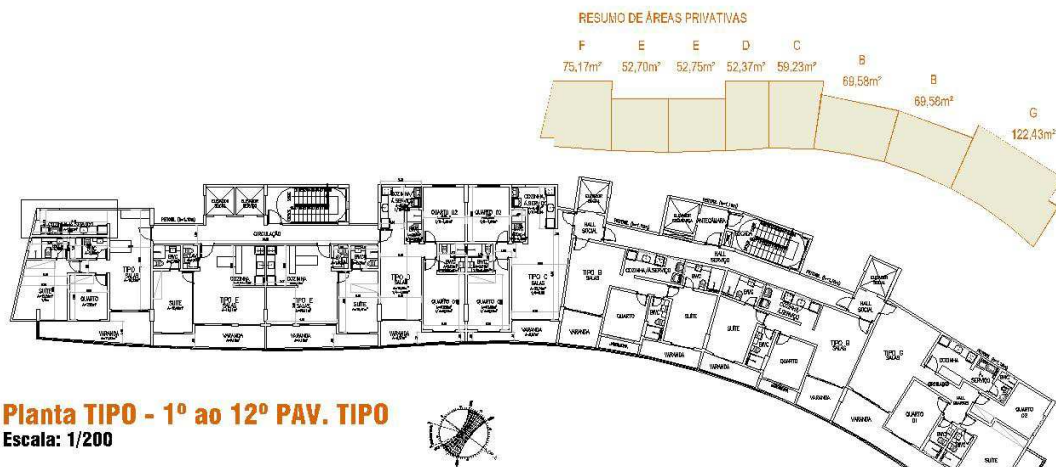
Plantas baixas dos pavimentos tipo do Estudo 03
